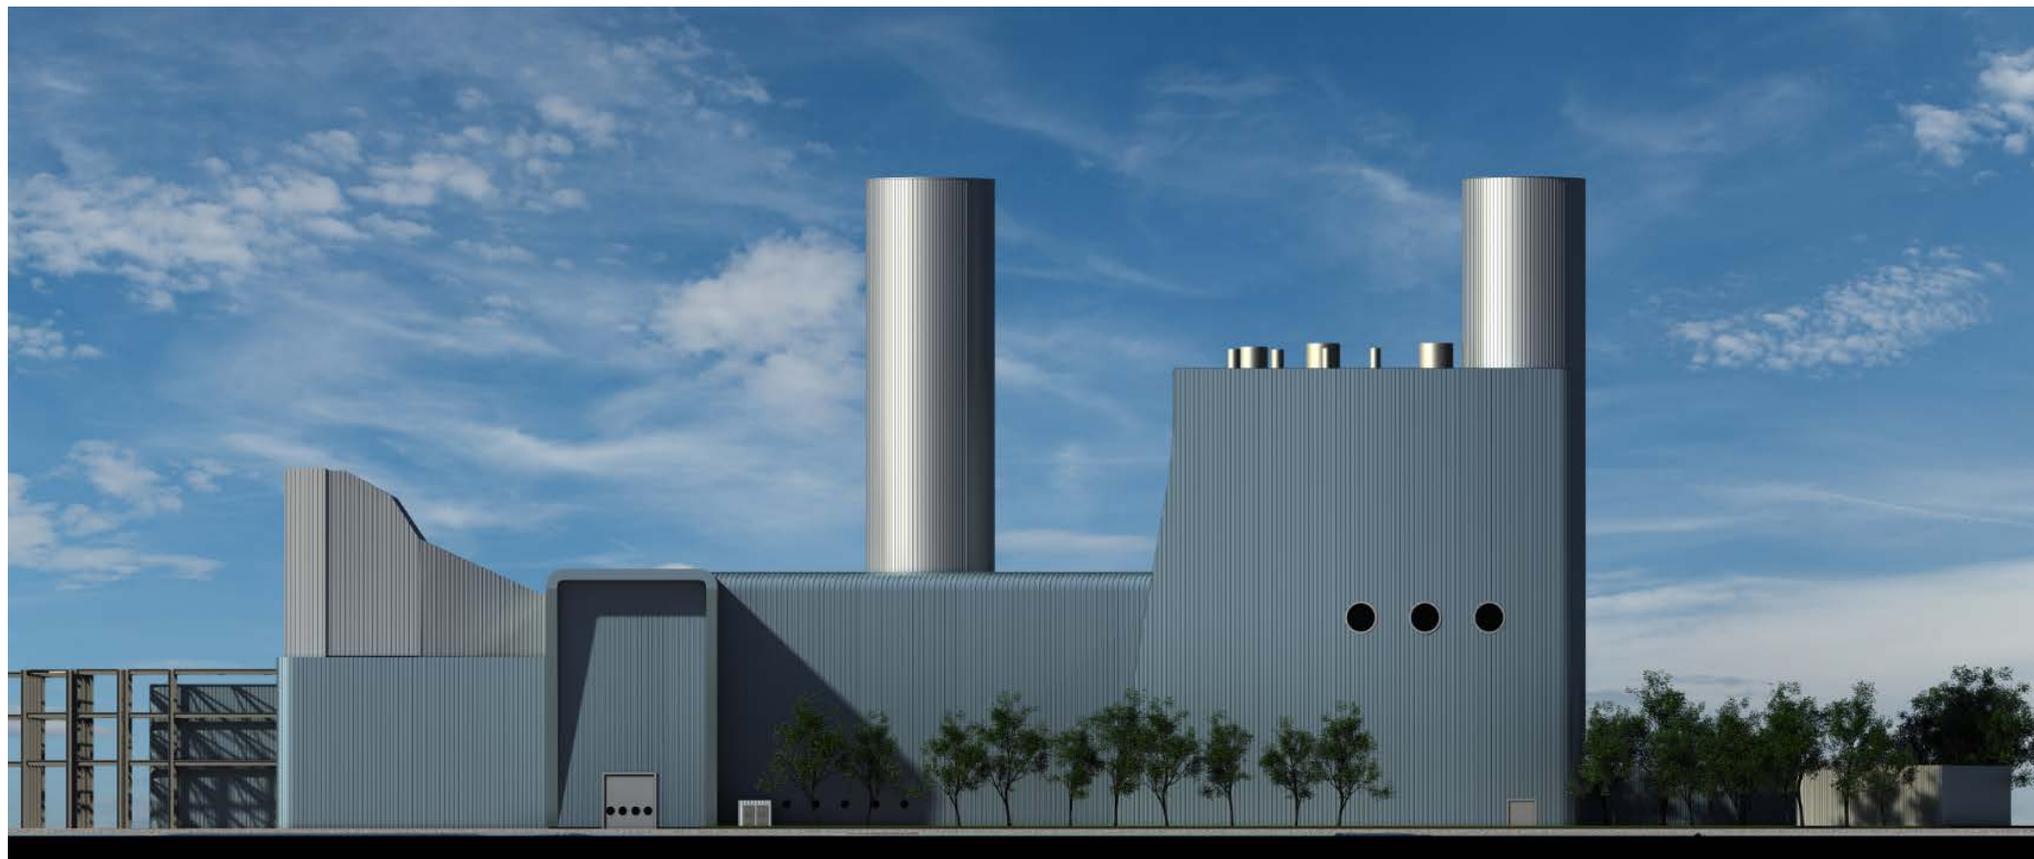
Modello 3d dell'impianto - Vista ortogonale da SE
